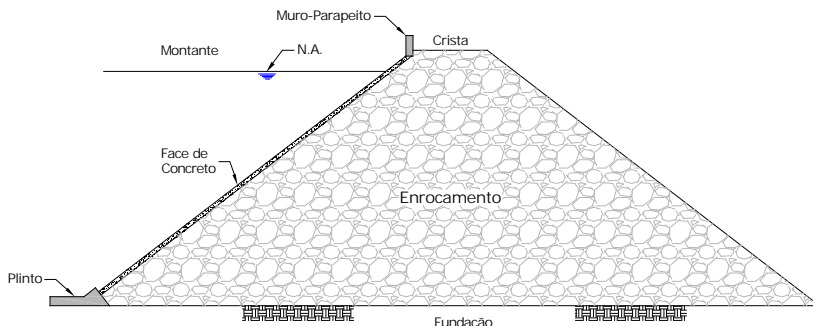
Seção transversal de uma barragem de enrocamento com face de concreto.
